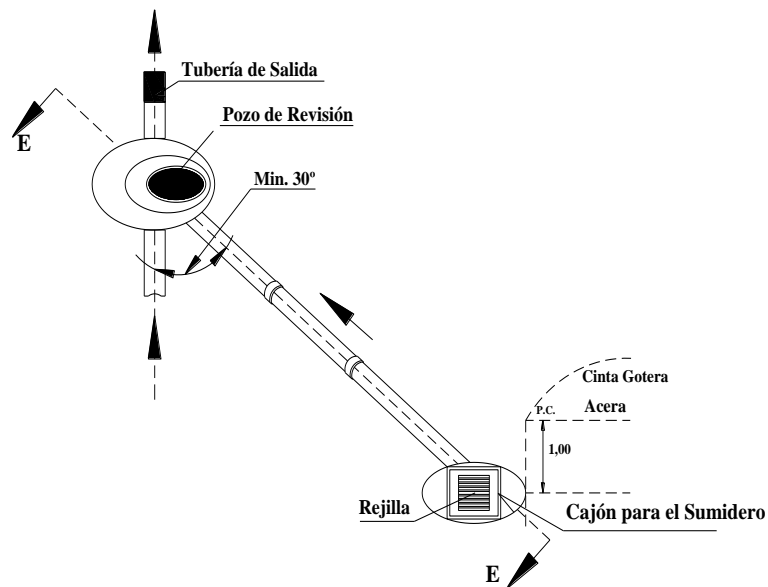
Acometida e Instalación Corte en Planta
